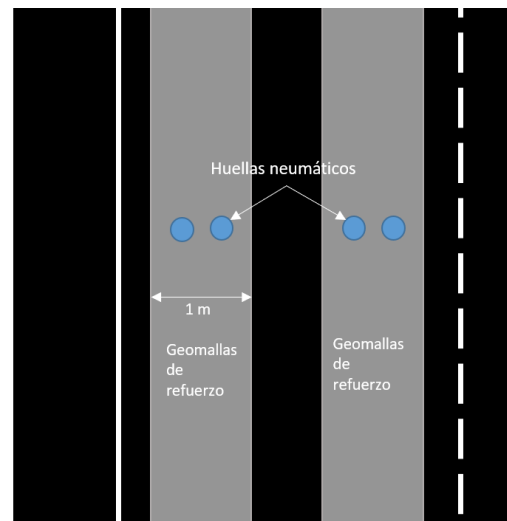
Esquema de posición en planta de Geomalla de Refuerzo. Fuente: Elaboración propia.
